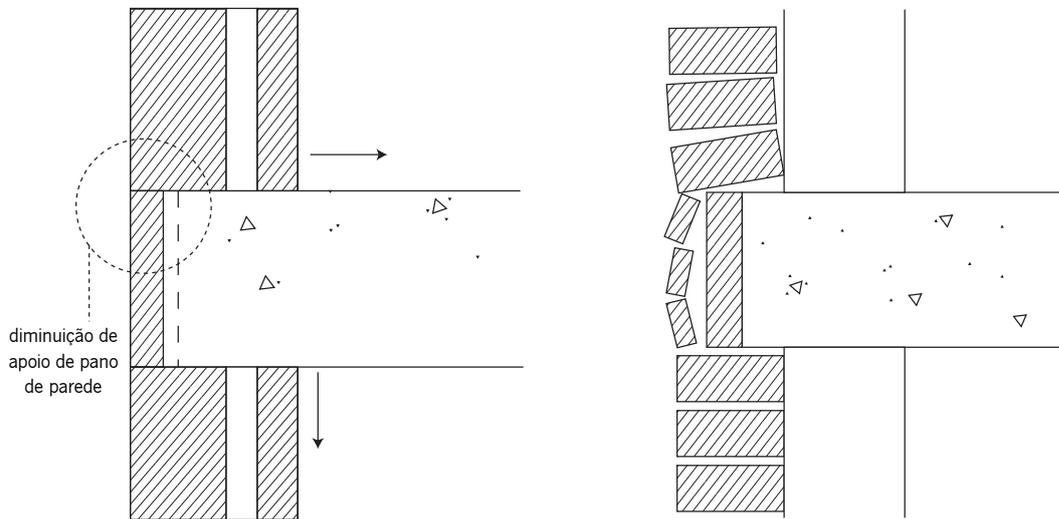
Fissuração horizontal e desprendimento do revestimento junto à laje & Fissuração horizontal e desprendimento das forras cerâmicas de correção térmica
